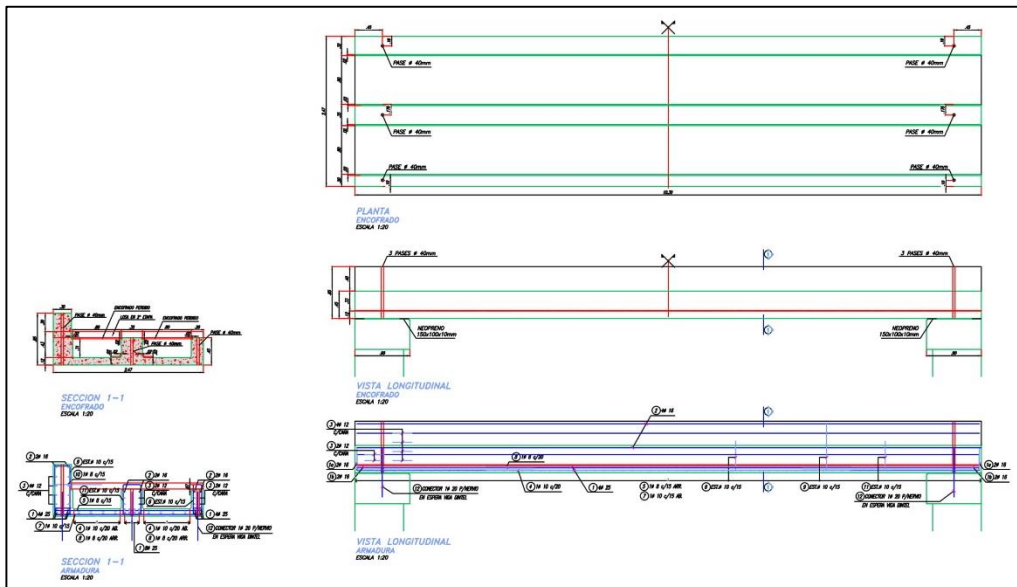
Detalle viga de borde. (PLANO N° 21)
